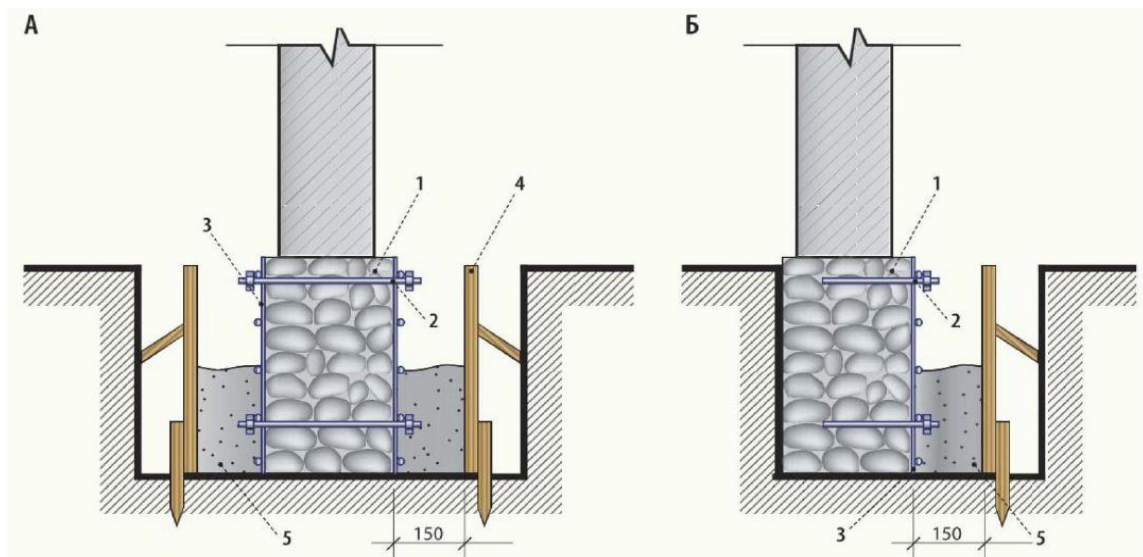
Схема посилення фундаменту бетоном: А – двостороннє; Б – одностороннє: 1 – бутовий фундамент; 2 – анкер; 3 – арматурна сітка; 4 – опалубка; 5 – бетонна суміш
